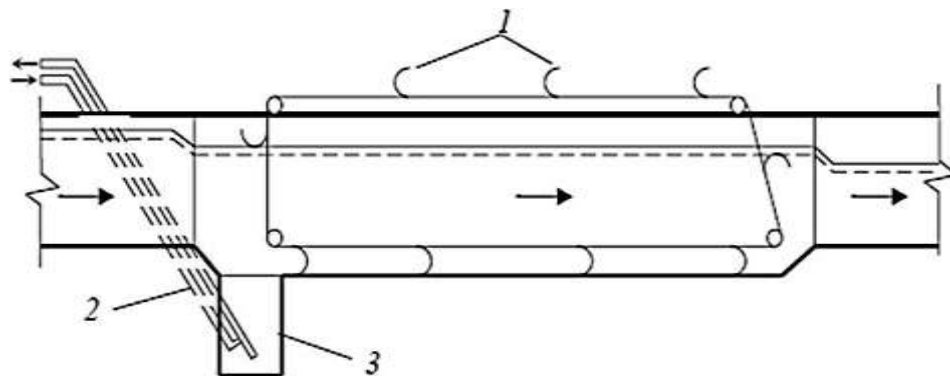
Горизонтальная песколовка с прямолинейным движением воды: 1 – цепной скребковый механизм; 2 – гидроэлеватор; 3 – бункер
